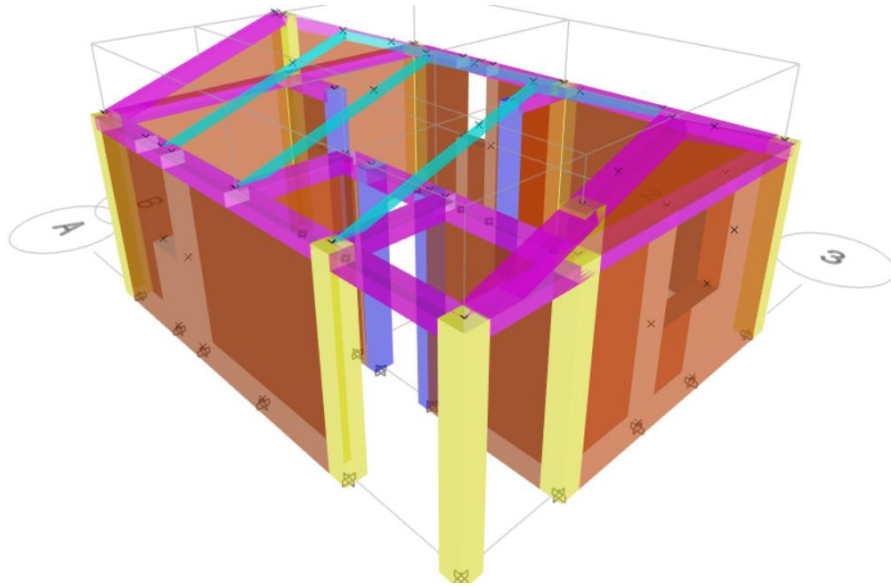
Modelamiento estructural - vivienda de albañilería confinada.
